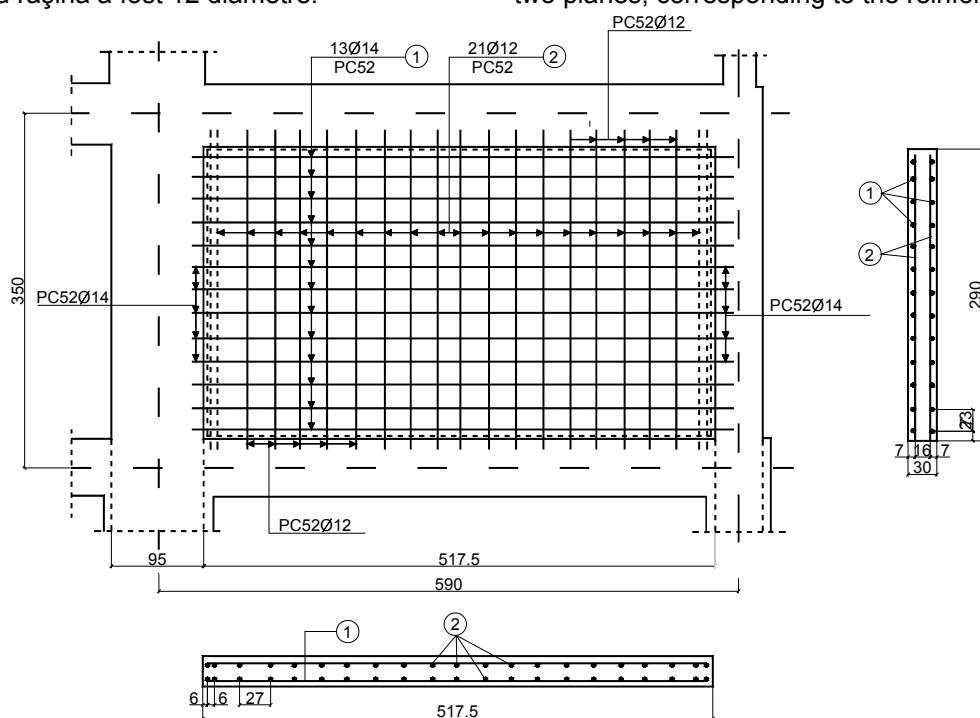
Armarea pereților de consolidare. Schema de dispunere a ancorelor / Reinforcement of infilled walls. Installing of bonded anchors scheme.
